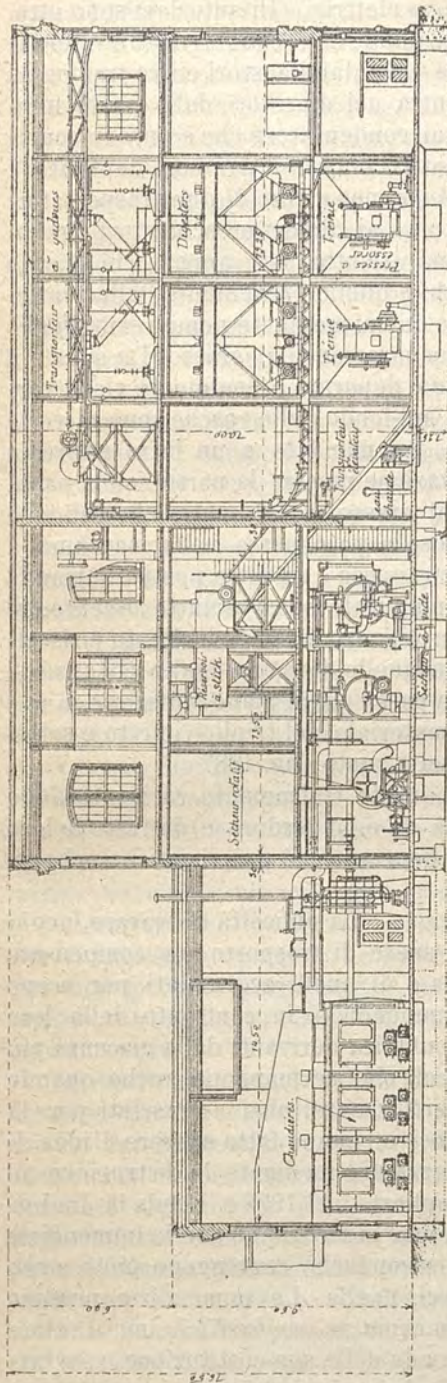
b. — Sezione longitudinale dell'impianto.
